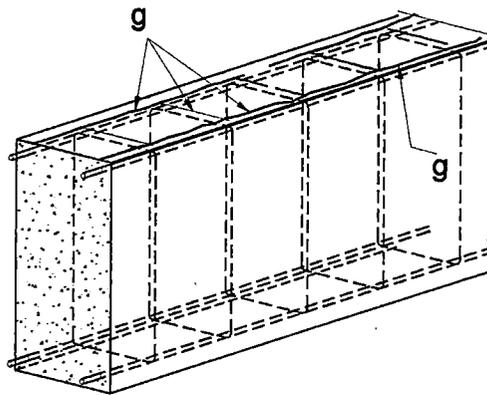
Agrietamiento por asiento plástico en viga
